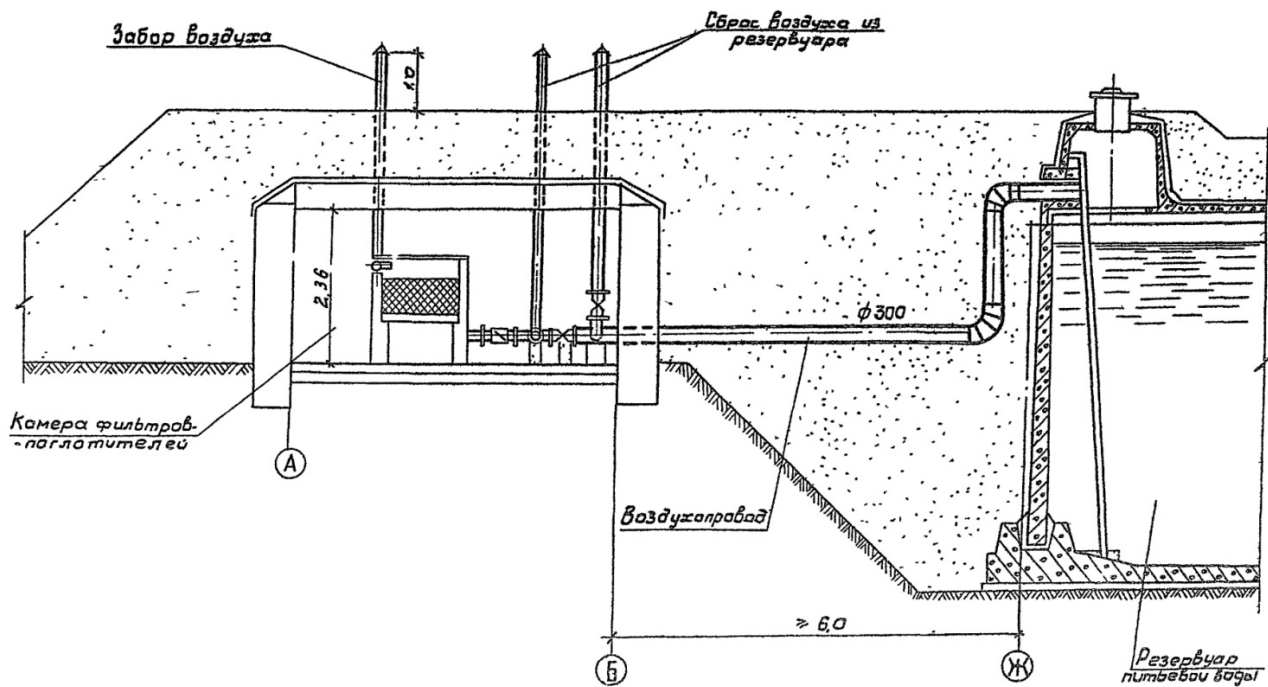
Пример расположения камеры ФП и резервуара [5]
